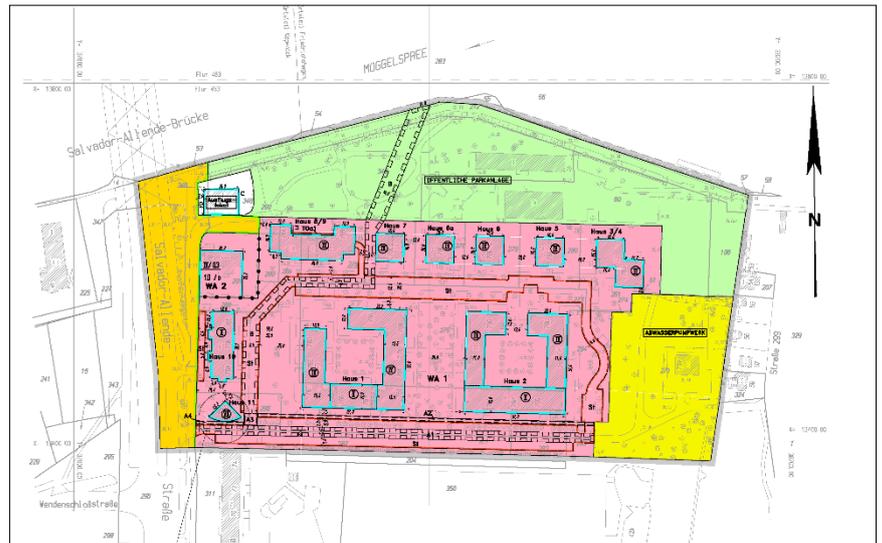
Bauungsplan XVI-24 (Ausschnitt der Planzeichnung, ohne Maßstab)
